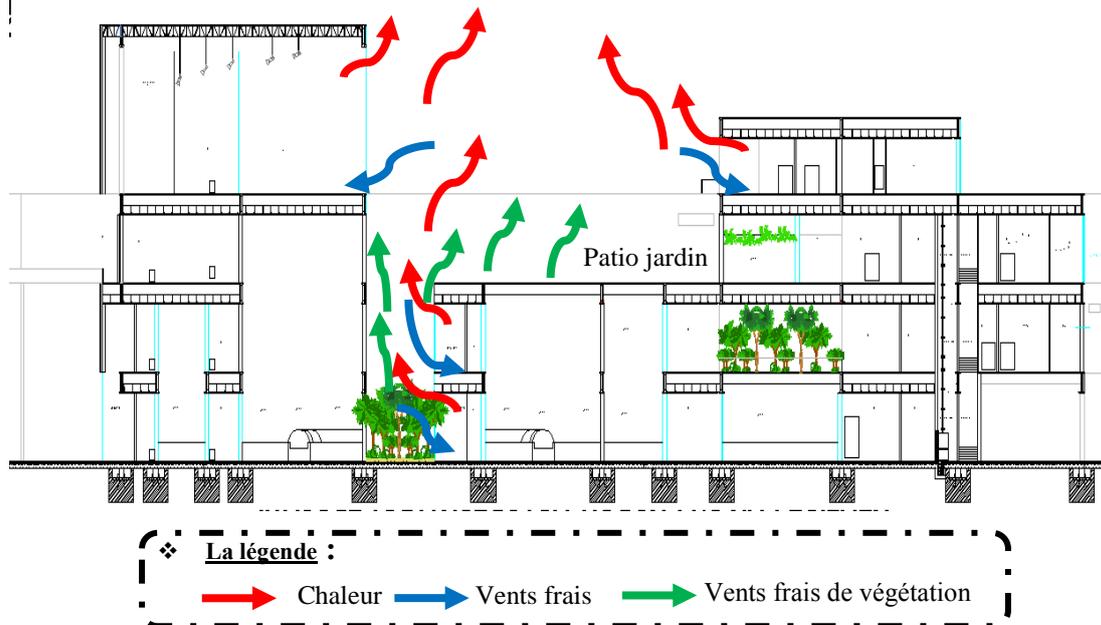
Coupe schématique sur la ventilation naturelle à travers le patio jardin pavillon C
